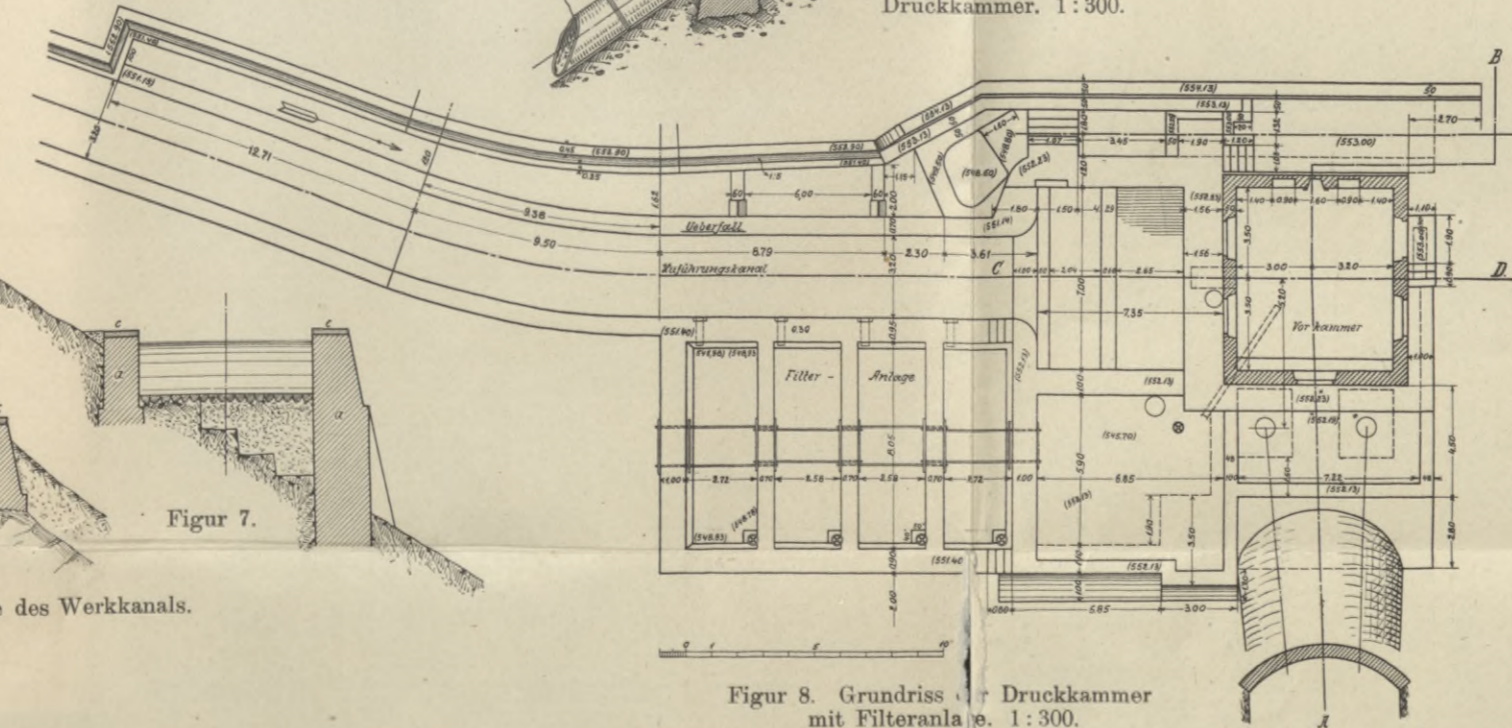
Grundriss der Druckkammer mit Filteranlage. 1:300.
